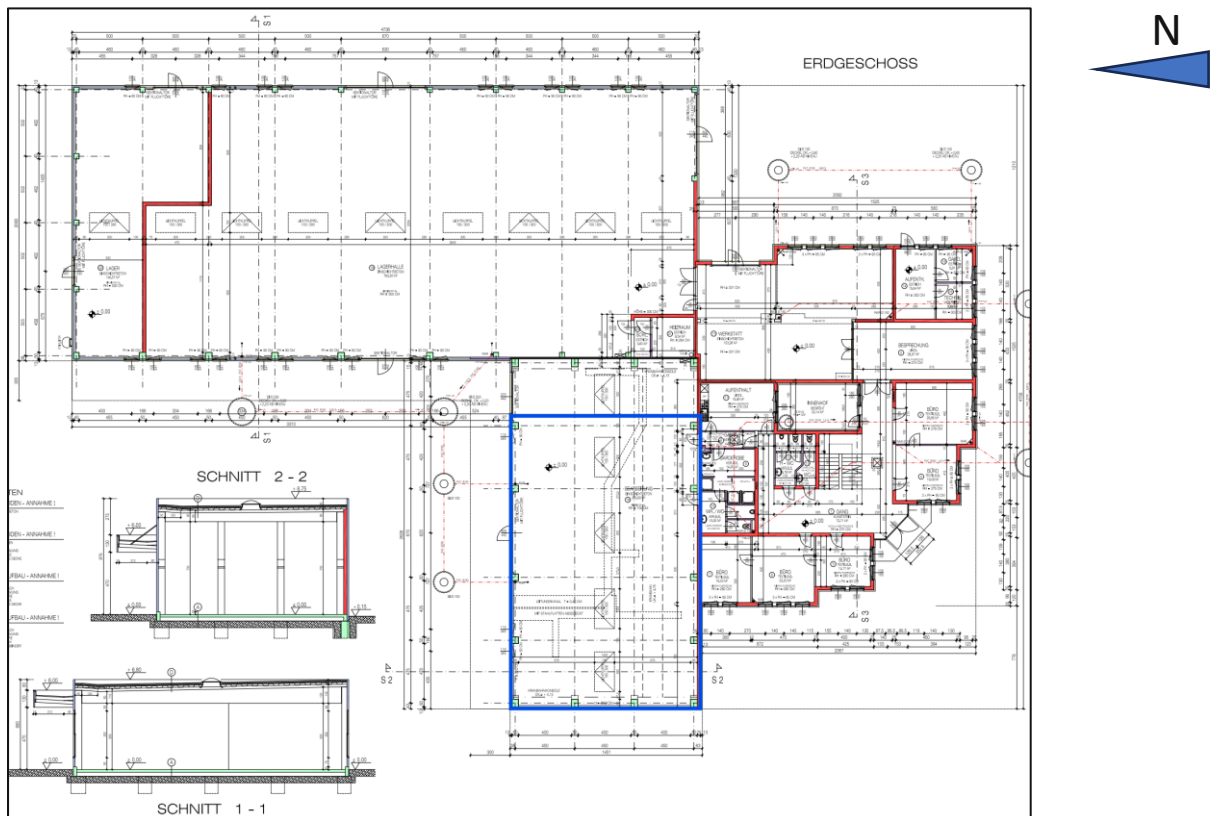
Grundriss im EG des Use Case B mit blau markiertem Scanbereich [41]
